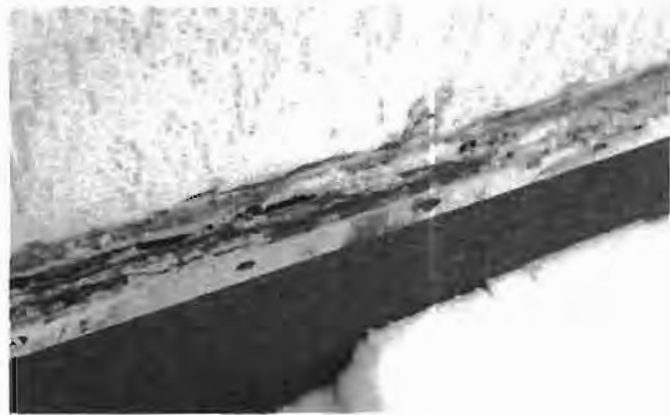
, 4. Фрагмент примыкания гидроизоляционного ковра к стенке вентиляционной шахты в осях Жс-Кс/2с (по проекту шифр 07.001.74/14-04Б-АРЗ, 3 секция, лист 5). Разрушение герметика, образование ледяных и водяных линз под материалом гидроизоляции. Отслоение от стены материала гидроизоляции. Следы грязи и пыли на герметике и под прижимной металлической планкой. Трещины по поверхности герметика.
